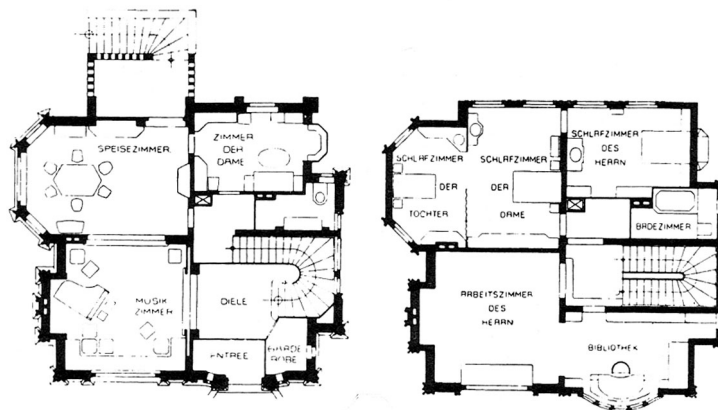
P. Behrens, *Haus Behrens*, *Grundrisse EG und 1. OG*, Darmstadt 1901
